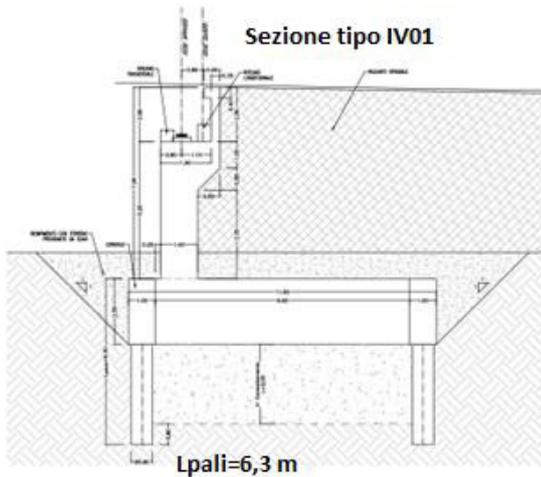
Sezioni tipo delle fondazioni indirette.
